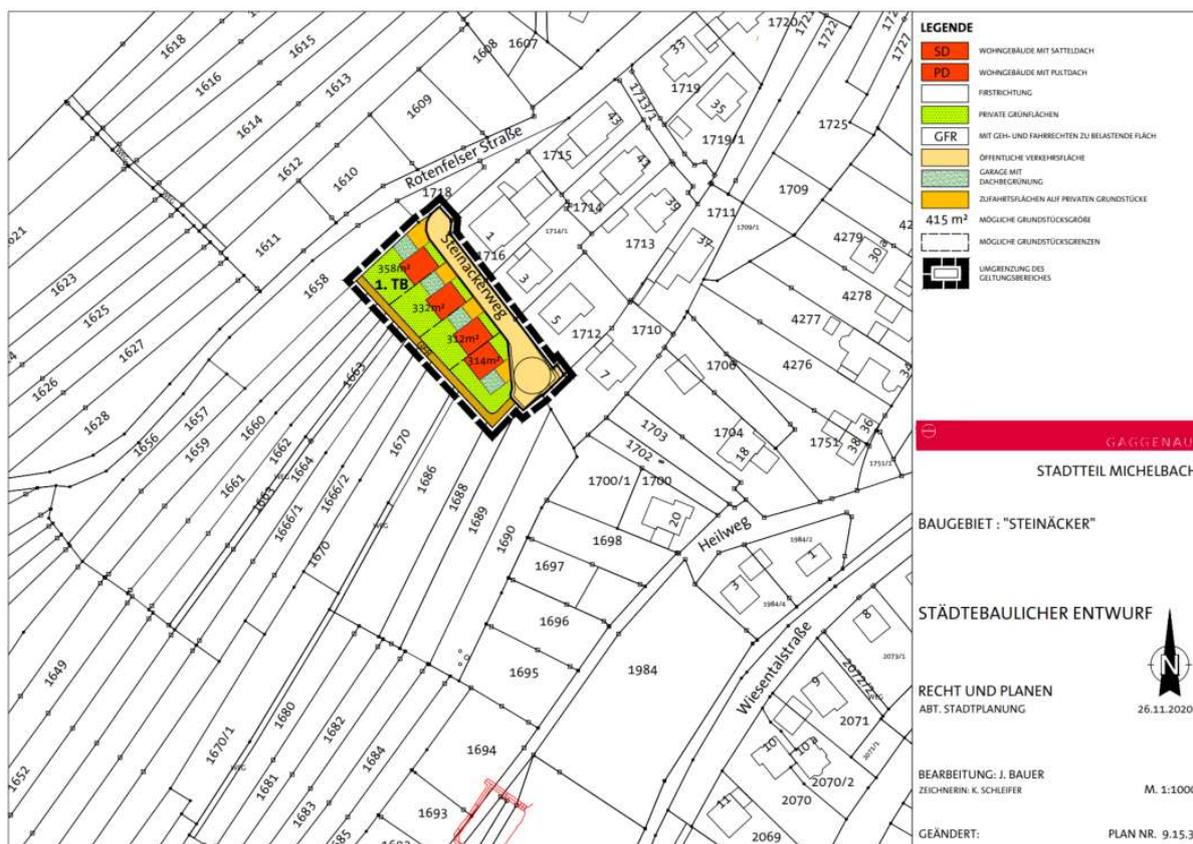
Städtebaulicher Entwurf – Anlage 2 für das geplante Baugebiet „Steinacker“, TB1. Quelle: Stadtverwaltung Gaggenau Amt für Recht und Planen – Stadtplanung Gaggenau (Stand: 26.11.2020).
